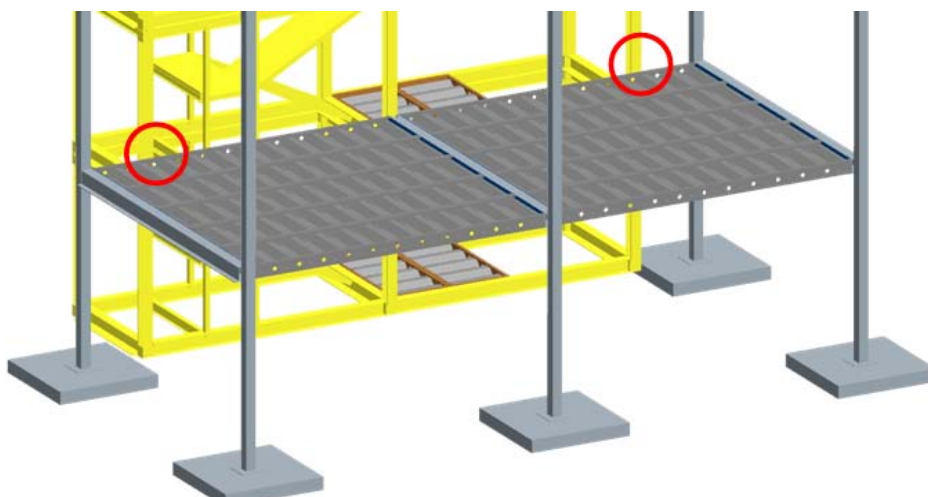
Puntos de apoyo adicionales entre planta y núcleo
